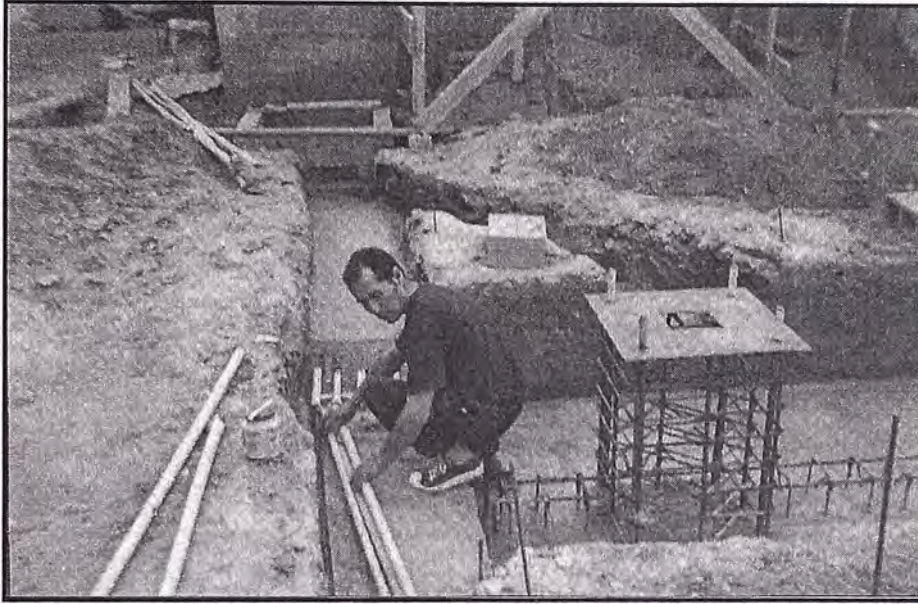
Las tuberías eléctricas llegan a la caja de paso de albañilería, están se rellenan con arena cemento en toda su trayectoria, deacuerdo a las especificaciones técnicas.
